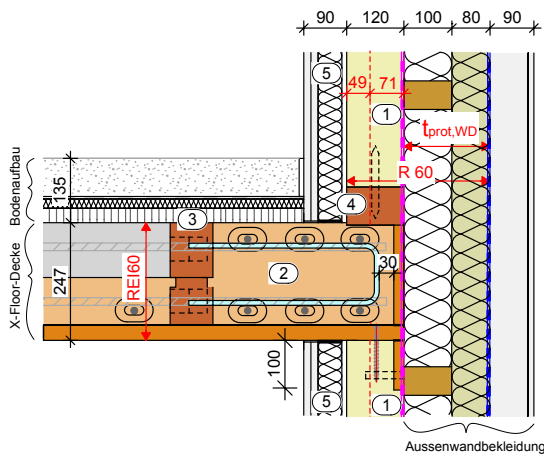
Auflager der Geschossdecke auf der Aussenwand
